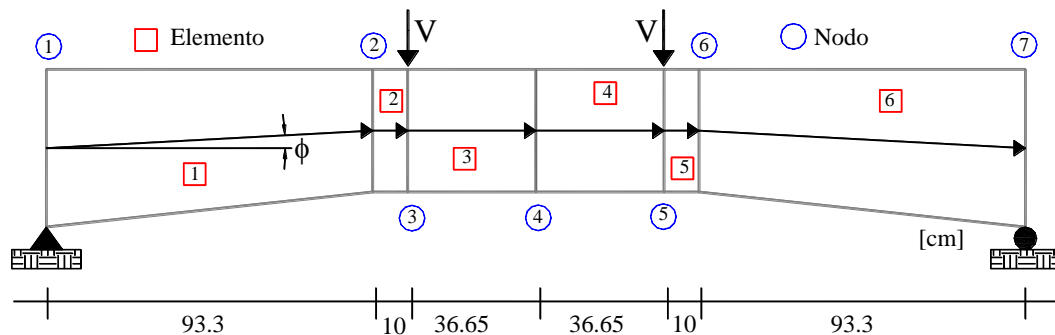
Modelo típico con los elementos tipo viga-columna
